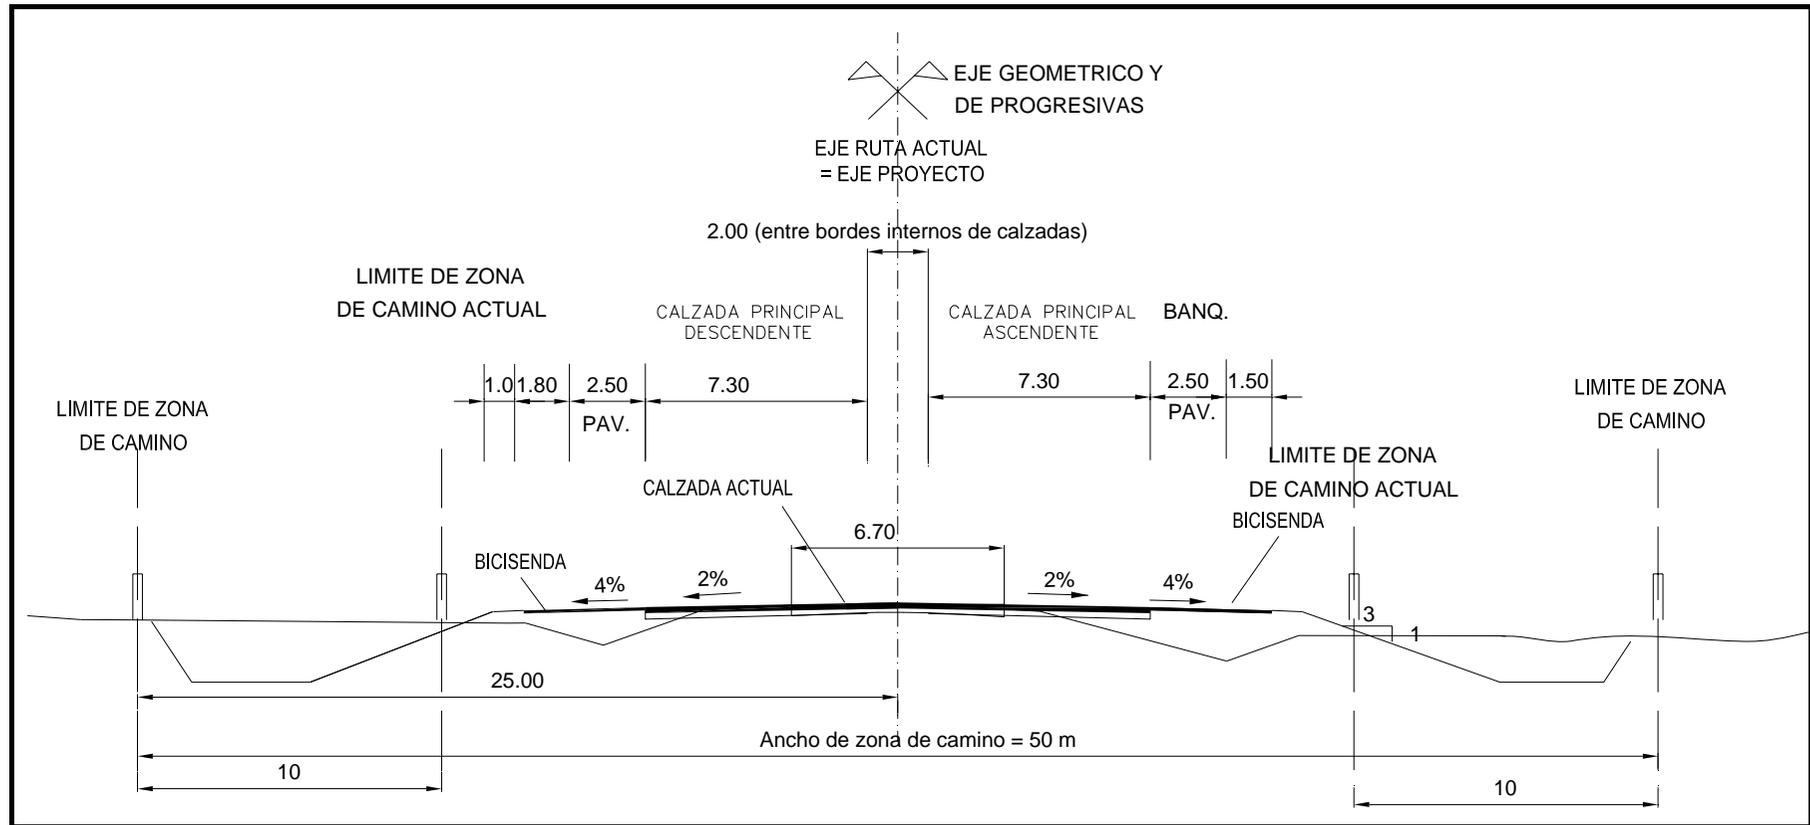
Croquis Tipo 2: perfil de diseño en zona Suburbana (Tramo 1, Sección 2).
